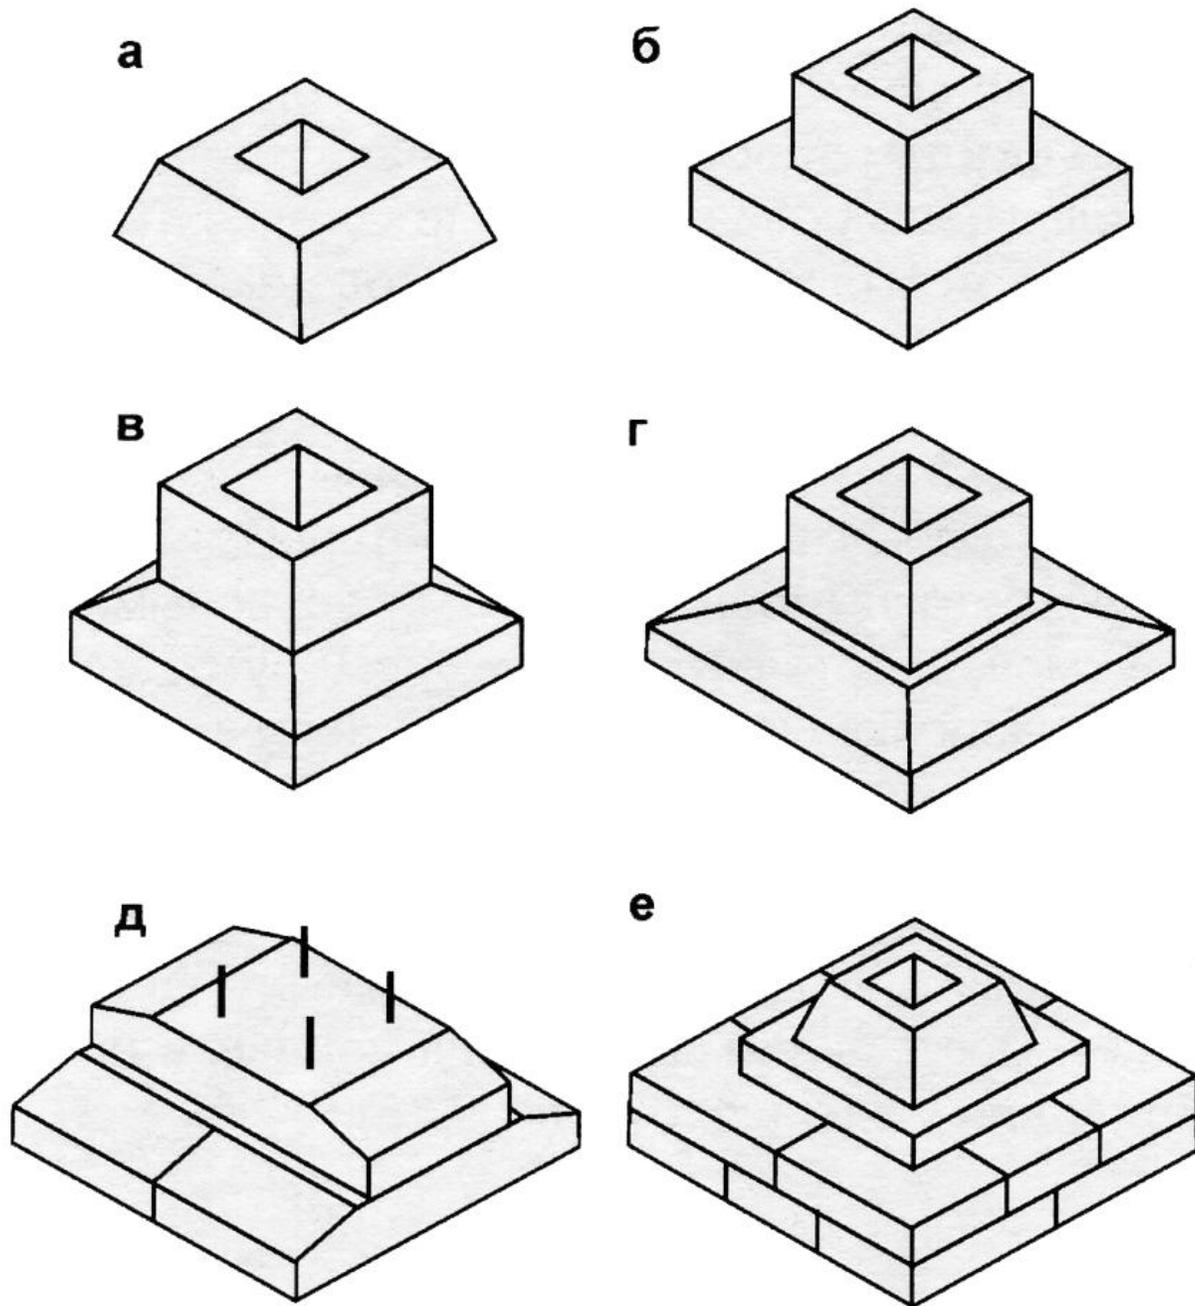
Сборные железобетонные фундаменты под колонны:
